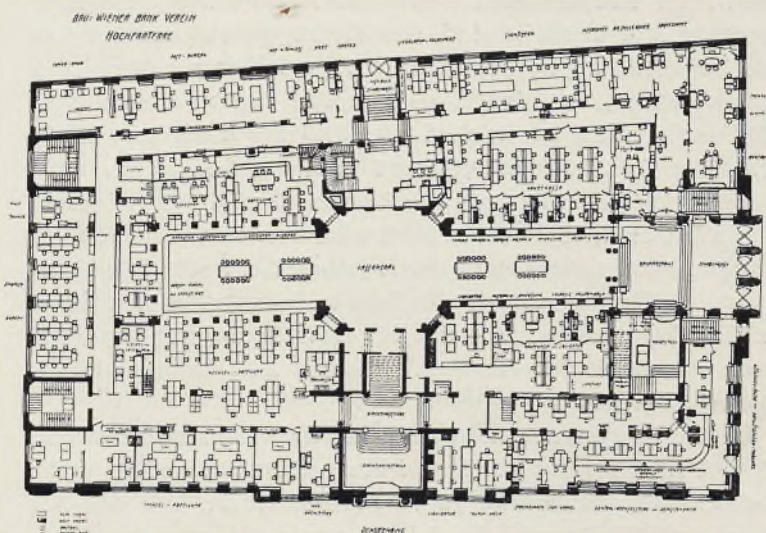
Grundriß des Bankvereins-Gebäudes.
